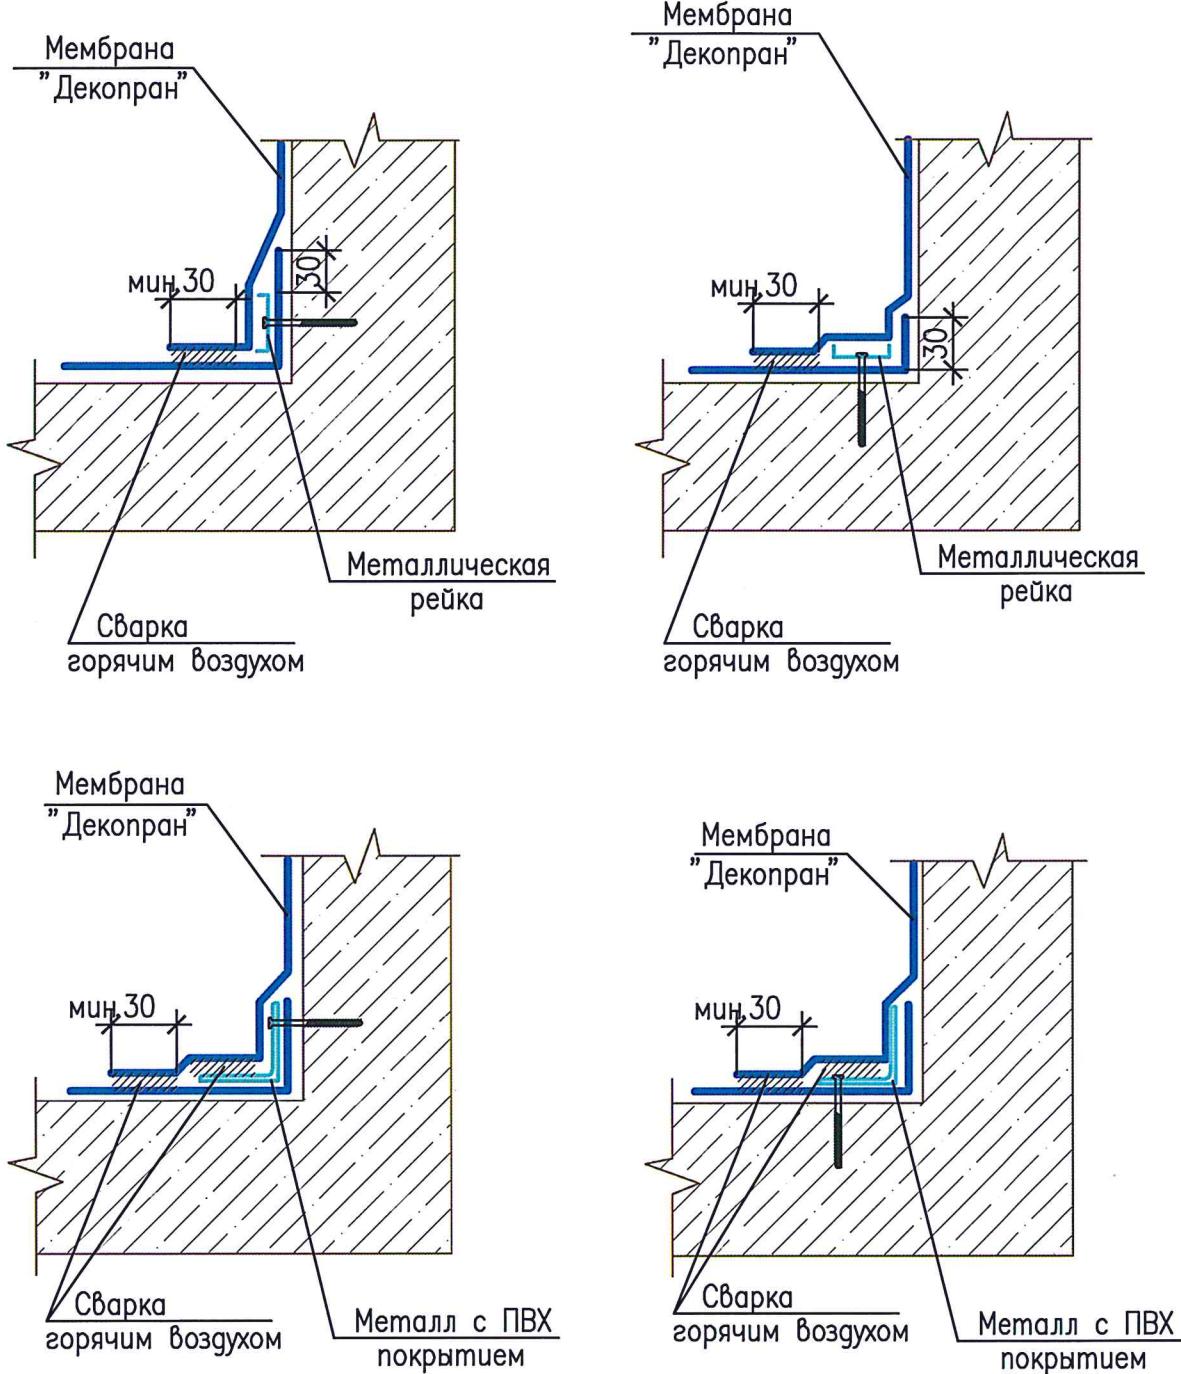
Механическое закрепление к железобетонному основанию.
